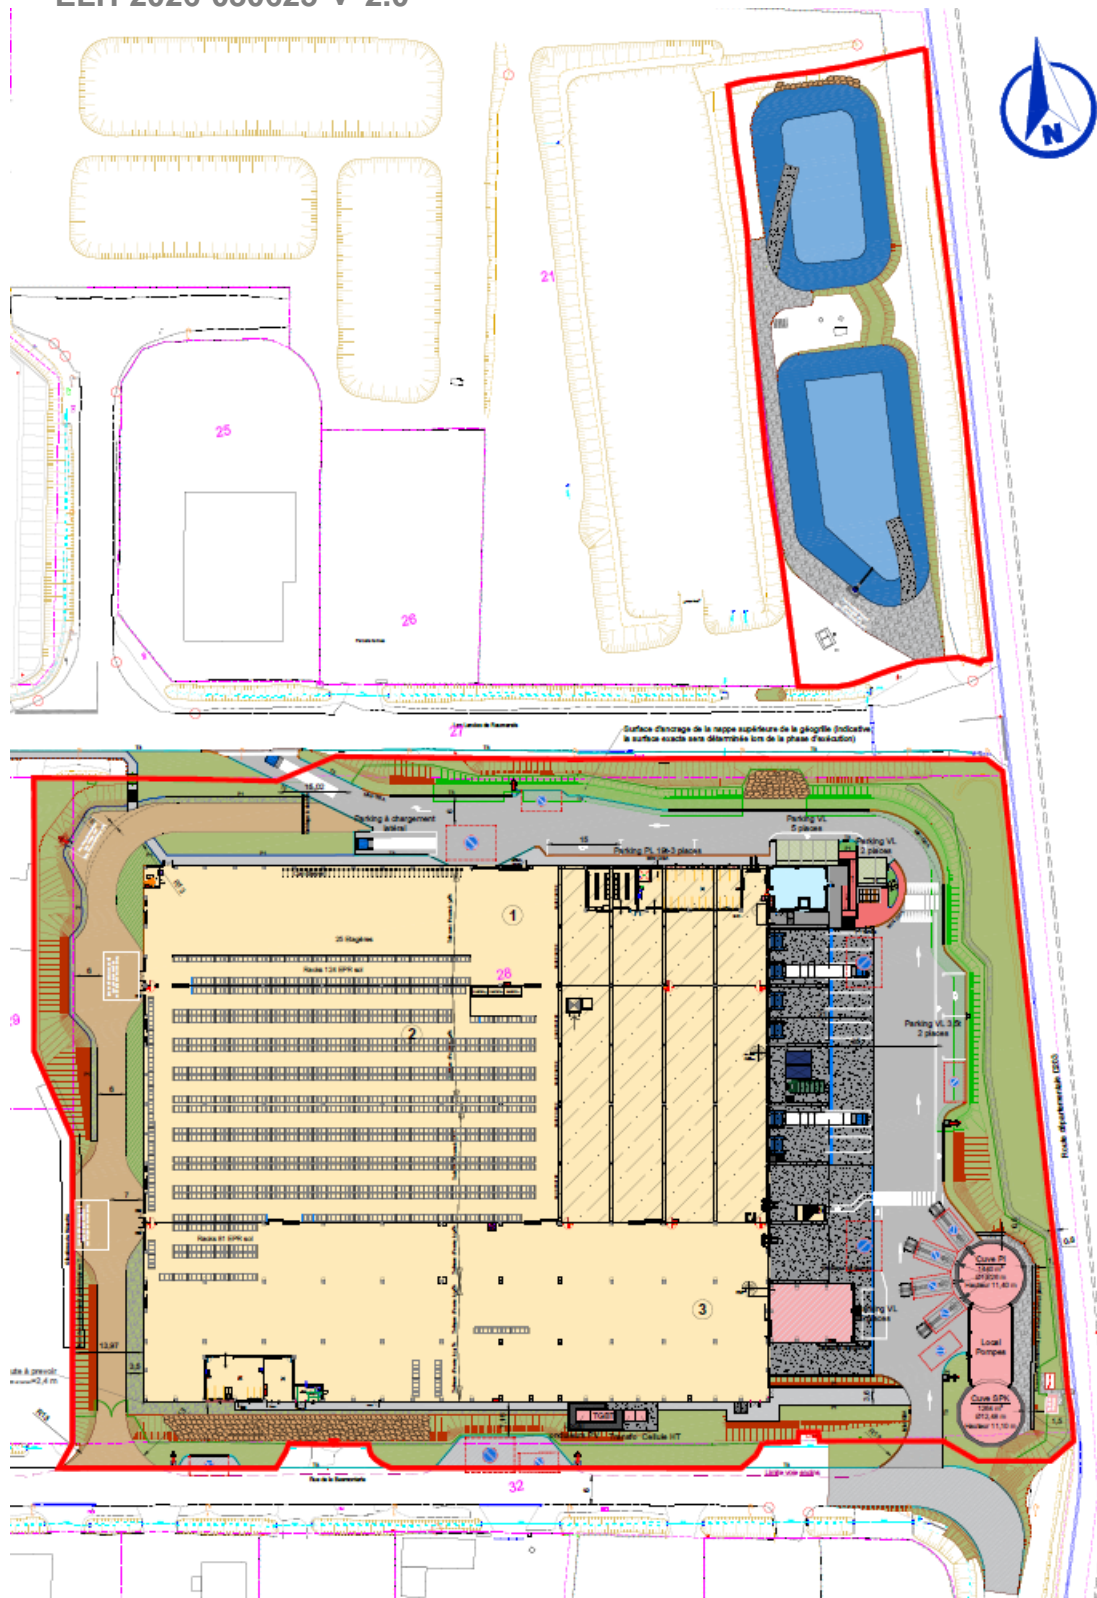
Plan du projet. Emprise ICPE dans l'encadré rouge
